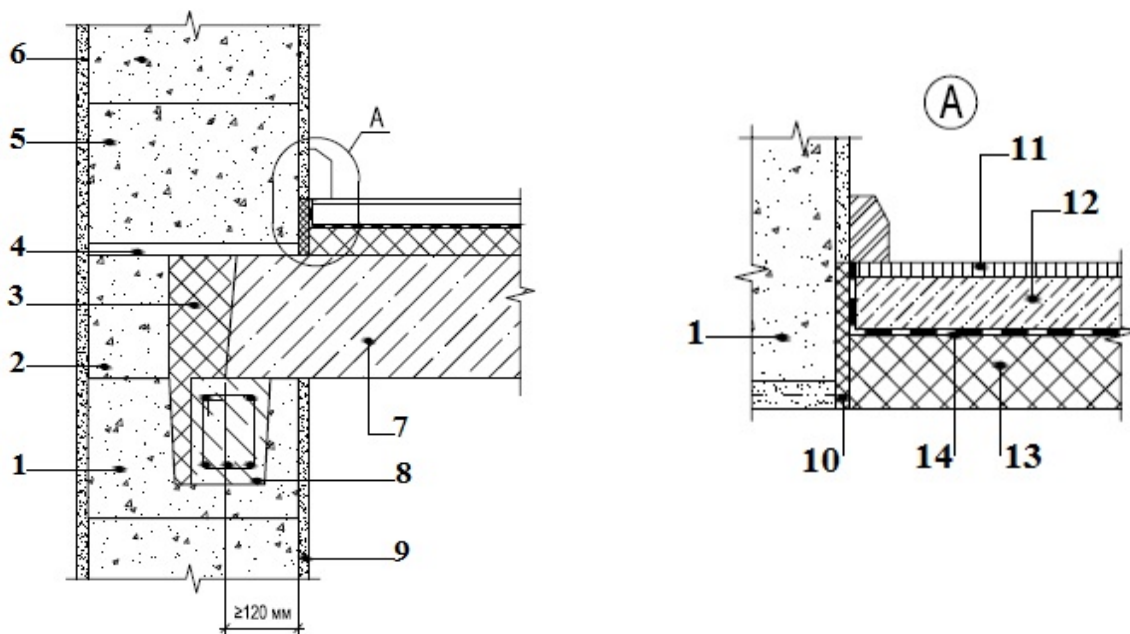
Узел опирания железобетонных плит перекрытий на наружную стену из газобетонных блоков: 1 — U-образный блок; 2 — доборный блок; 3 — минеральная вата или пенополистирол; 4 — шов из цементного раствора; 5 — блок YTONG; 6 — наружная отделка; 7 — сборные пустотные железобетонные плиты; 8 — монолитный железобетон; 9 — внутренняя отделка; 10 — пенополистирол; 11 — покрытие пола; 12 — цементная стяжка; 13 — утеплитель; 14 — гидроизоляция
